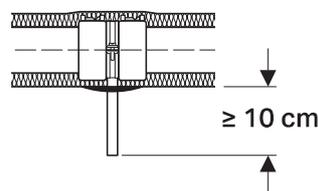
Fixpunkt für einbetonierte gedämmte Geberit PE Leitungen
